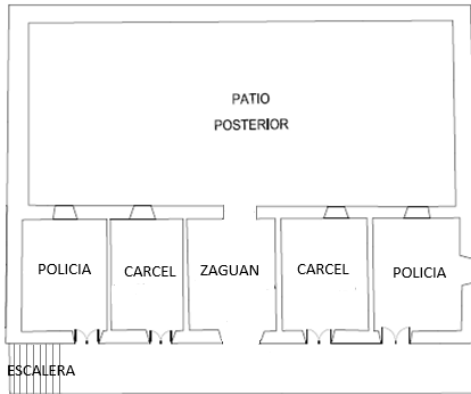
Planta primer piso original (Uribe et al., 2013)
